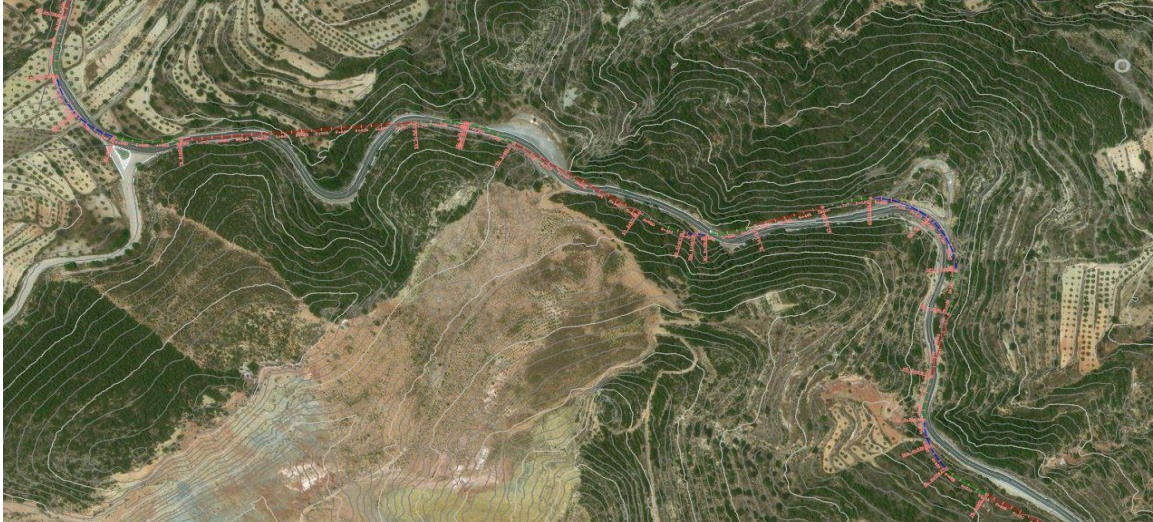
Propuesta del trazado. Fuente, Civil 3D
